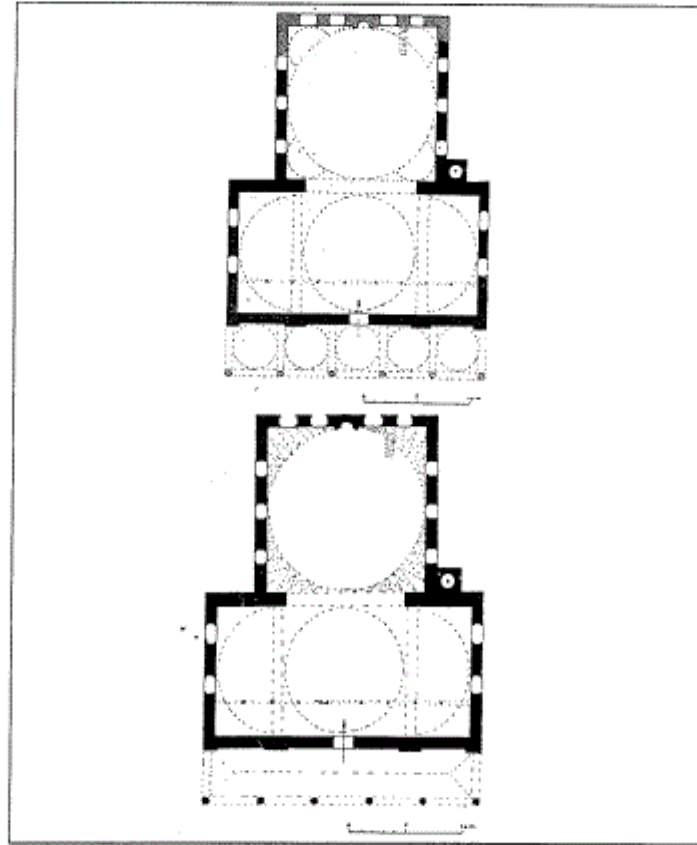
مسقط أفقي لمسجد كيل حسن أغا في روجوفو (عن : كيل) .
